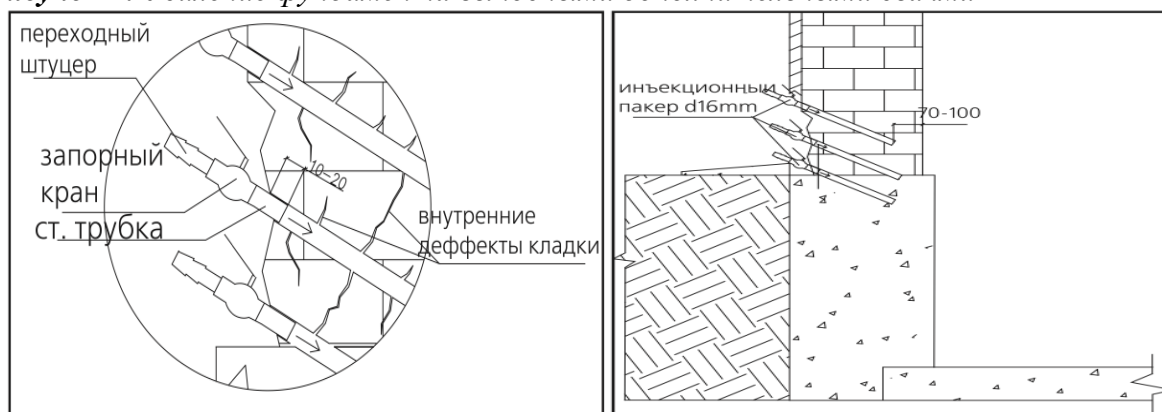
Усиление фундамента инъекционным нагнетанием
